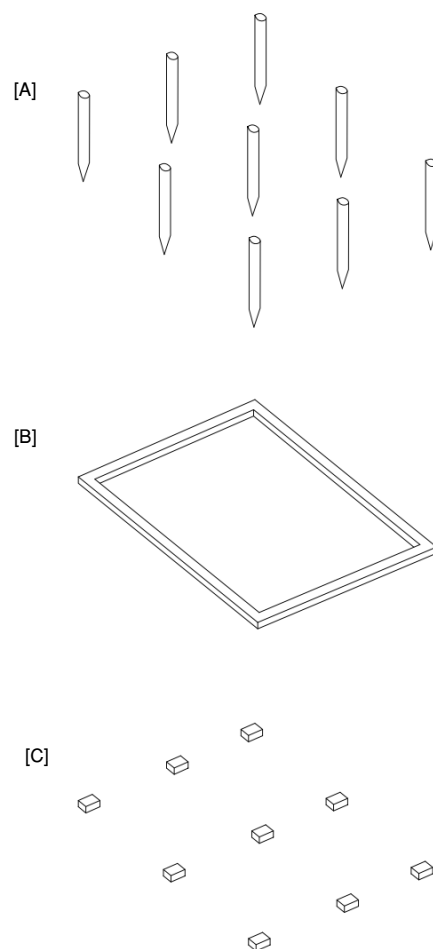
Tipos de fundações: [A] Estacaria em madeira; [B] Sapata corrida Betão; [C] Sapata isolada-Fundações Pontuais em Betão.
